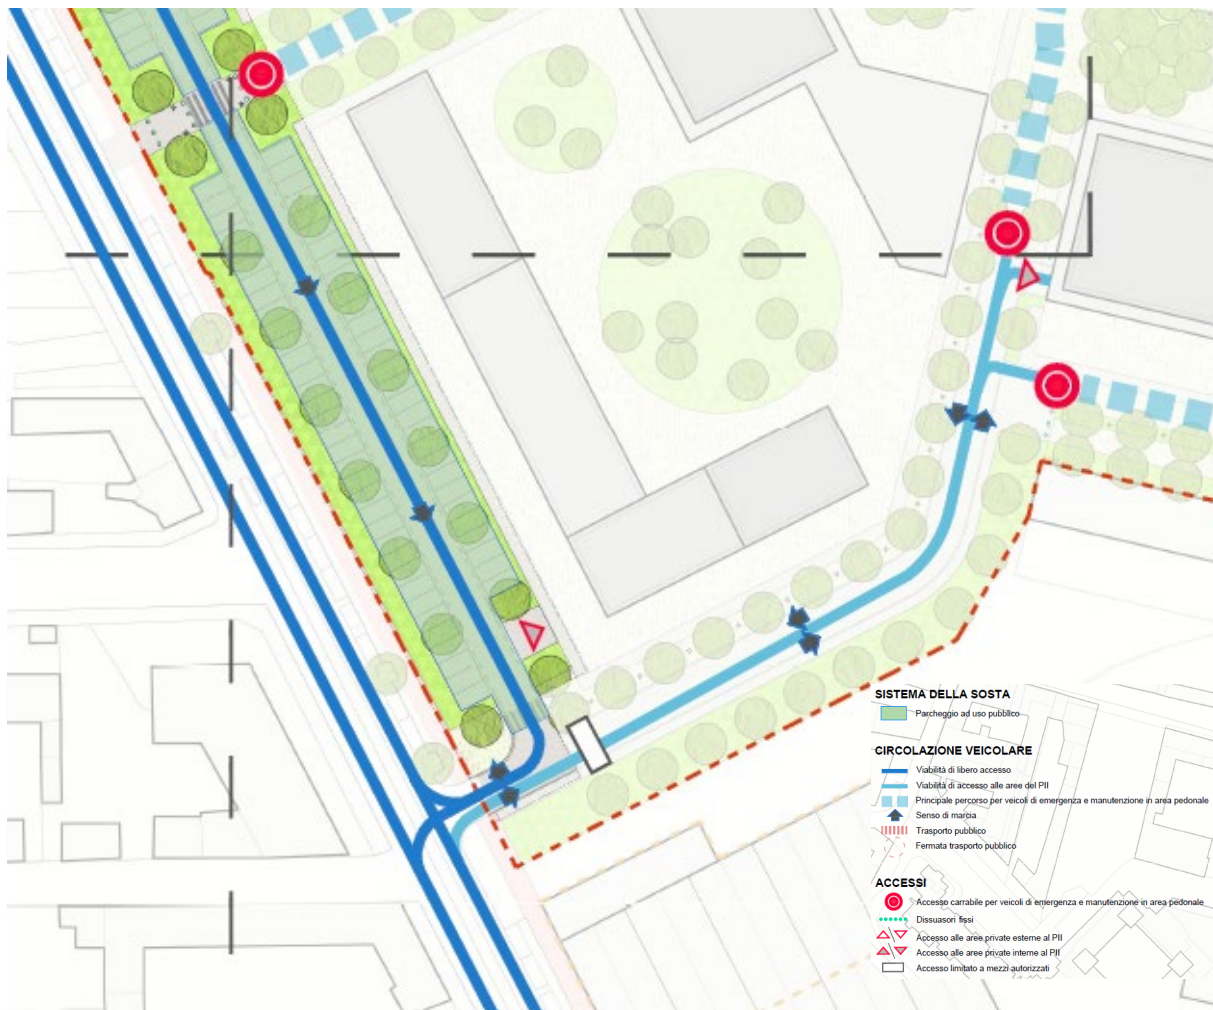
Schema di circolazione IN-OUT da carrai delle autovetture
